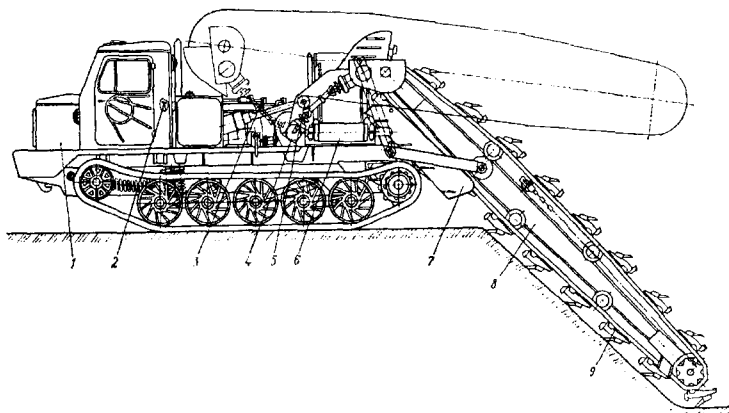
Траншейный цепной экскаватор с транспортной разгрузкой: 1 – трактор; 2 – органы управления; 3 – гидропривод; 4 – распределительная коробка; 5 – механизм подъема и опускания рабочего органа; 6 – конвейер; 7 – поток; 8 – рабочий орган; 9 – скребок.
